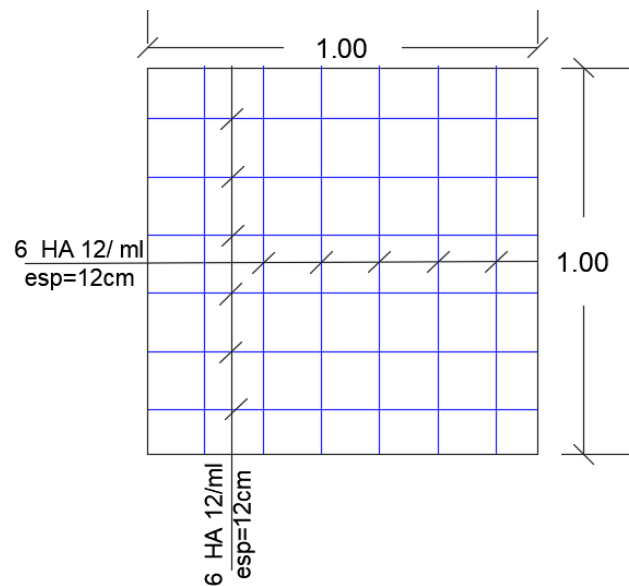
Schéma de ferrailage de la dalle du radier pour 1ml
